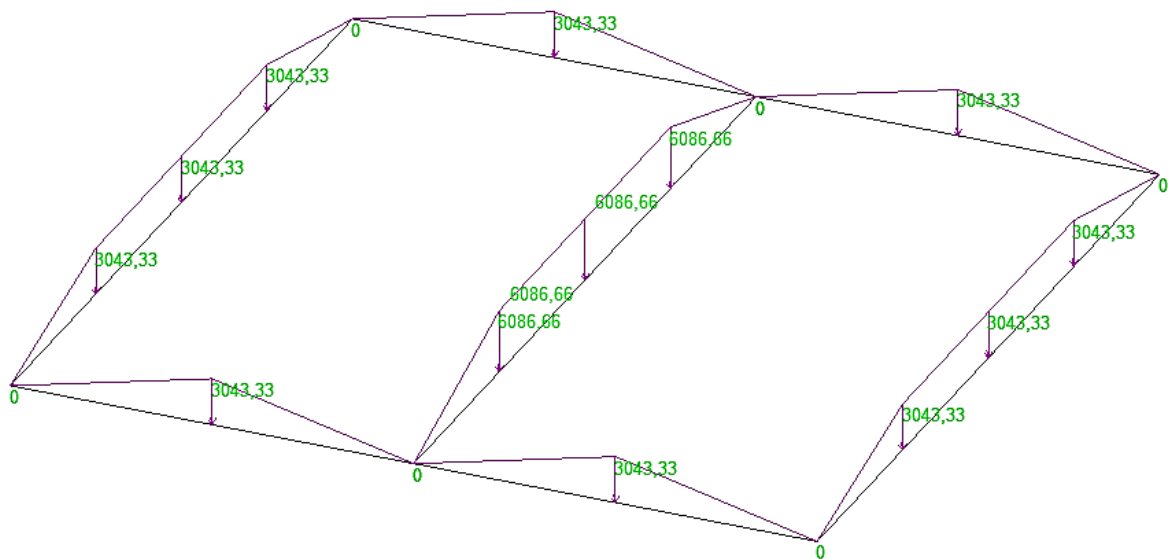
Распределение линейных нагрузок, собранных с железобетонного перекрытия. Форма распределения нагрузок обусловлена произведением нагрузок с площади на ширину грузовой площади: так в углу данное значение составляет 0, от 1/4 до 3/4 части грузовой площади – 3 метра, в соответствии с рисунком А.3 б.
